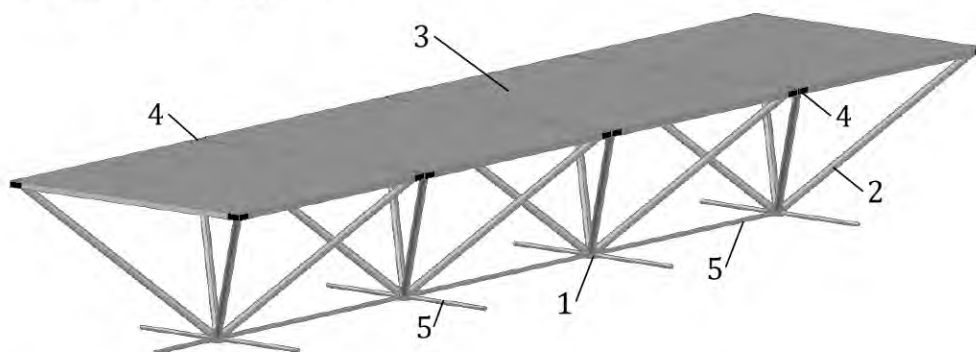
Збірний лінійний елемент сталезалізобетонного структурно-вантового покриття: 1 – вузол з'єднання по нижньому поясу; 2 – розкос; 3 – верхній пояс (армоцементна плита); 4 – закладна деталь; 5 – нижній пояс (гнучкий вант)
